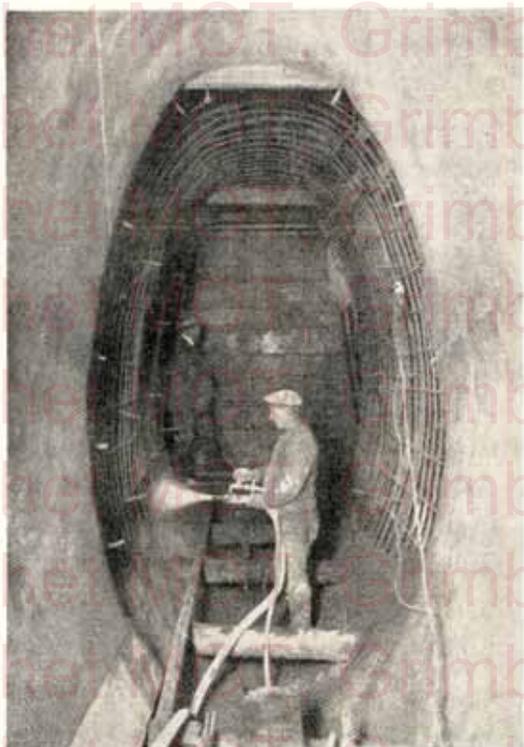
Exécution d'un enduit armé par le ciment-gun.
